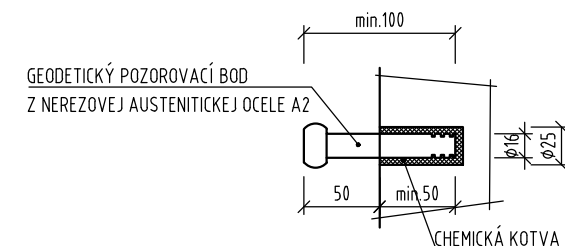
DETAIL GEODETICKÉHO POZOROVACIEHO BODU NA RÍMSE M 1:5
